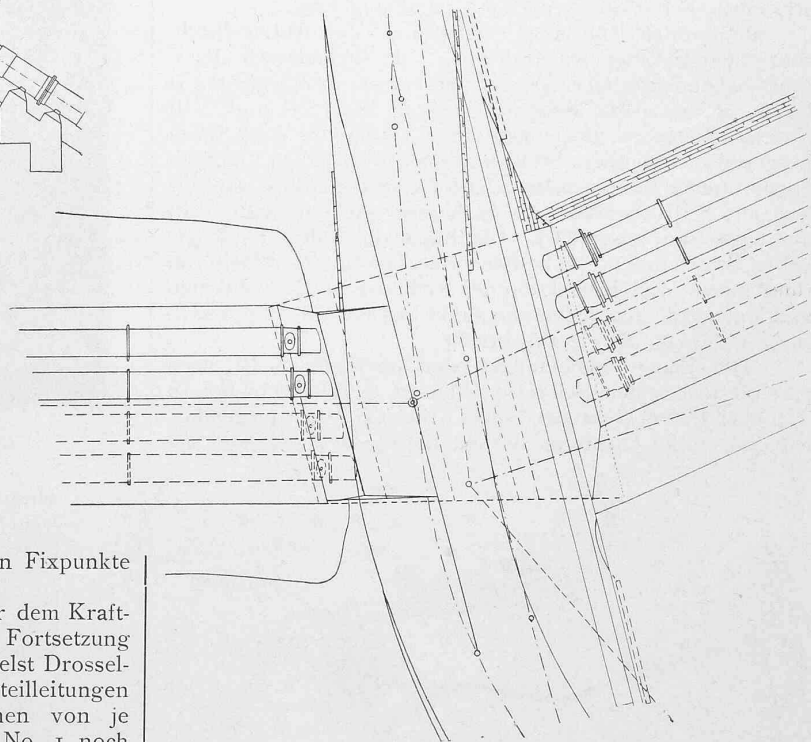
Druckleitung bei Fixpunkt S III und Unterführung der Strasse nach Engelberg. — Lageplan. — Masstab 1 : 250.
